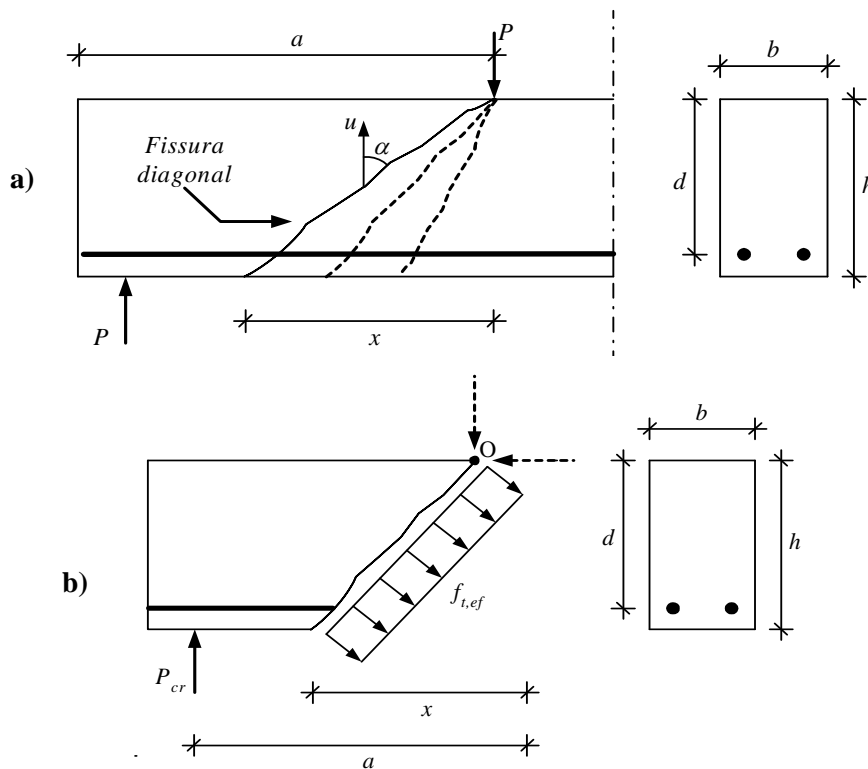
Modelo da fissura deslizante: a) fissura diagonal; b) distribuição de tensão na formação da fissura; adaptada de Hoang e Nielsen (1998).
